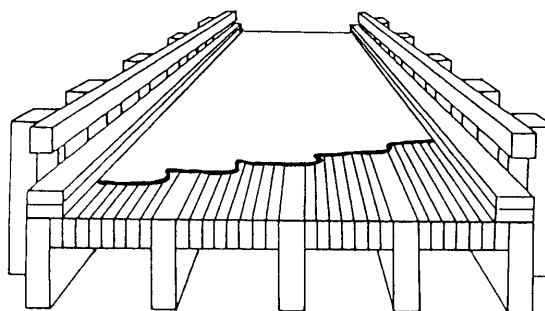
Ponte de madeira com vigas-T (OKIMOTO, 1997)
